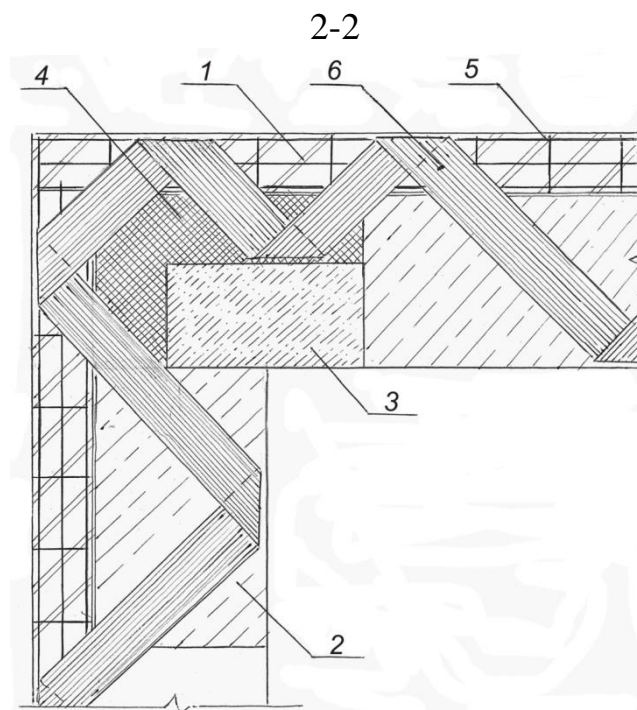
Конструкция самонесущей наружной стены: 1 - наружный слой из кирпича; 2 - внутренний слой из ячеистобетонных блоков с вариотропной паропроницаемостью
